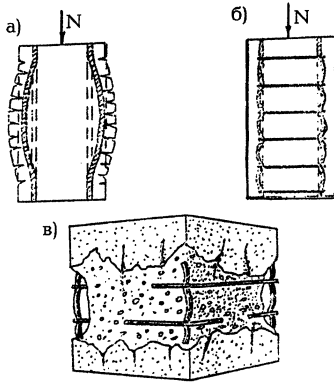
Характер силовых повреждений сжатого железобетонного элемента с малым или случайным эксцентриситетом при потере устойчивости продольной арматуры: а - при отсутствии или большом шаге поперечных стержней; б-при частом расположении поперечных стержней; в- в стадии разрушения
